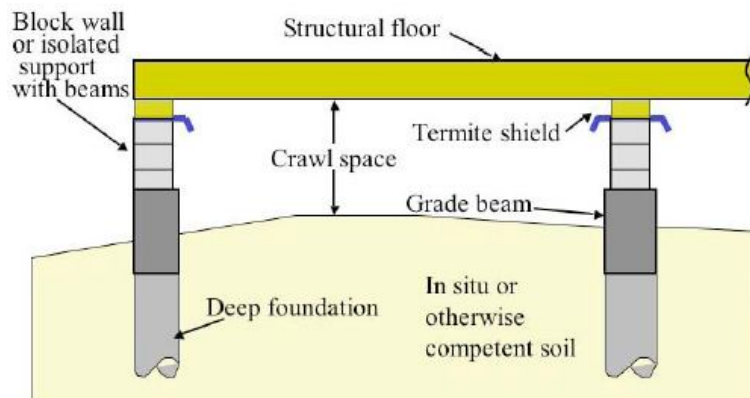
Piso estrutural com espaço livre e fundações profundas (SCFPA, 2004).
